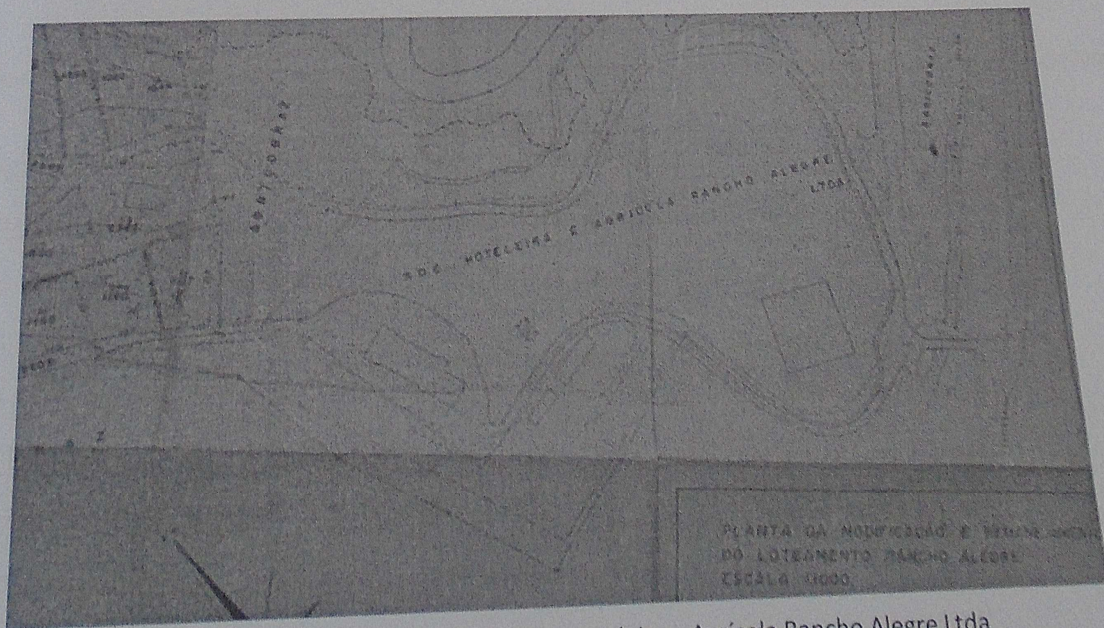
Planta da área da Sociedade Hoteleira e Agrícola Rancho Alegre Ltda
